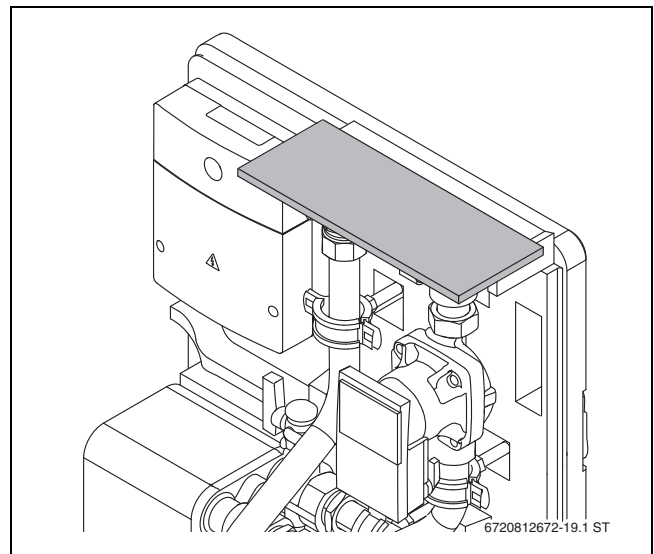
Anschlüsse oben während der Montagearbeiten abdecken
